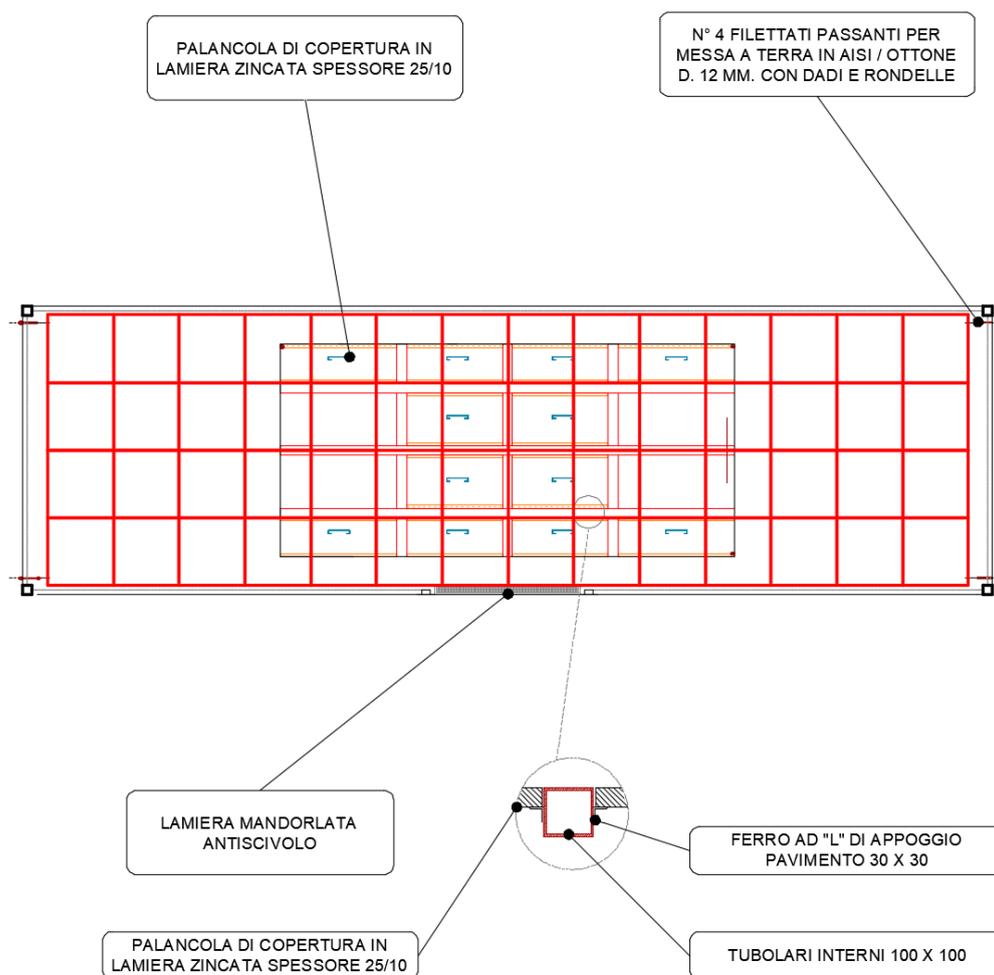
Planimetria impianto di terra Cabina di smistamento
